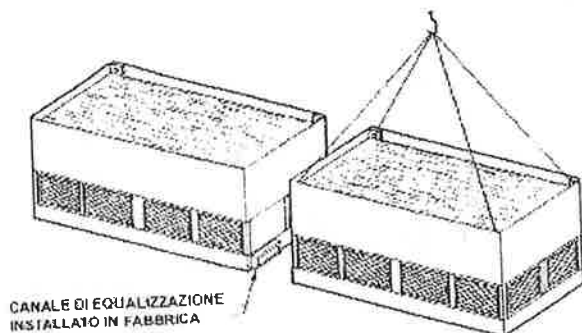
Dettaglio sollevamento e posizionamento canale di equalizzazione
